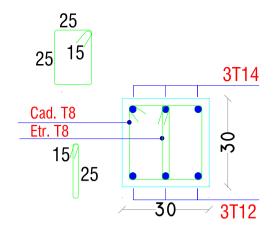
Ferraillage des poutres secondaire pour Etage 2,3,4,5,6,7 et 8.
